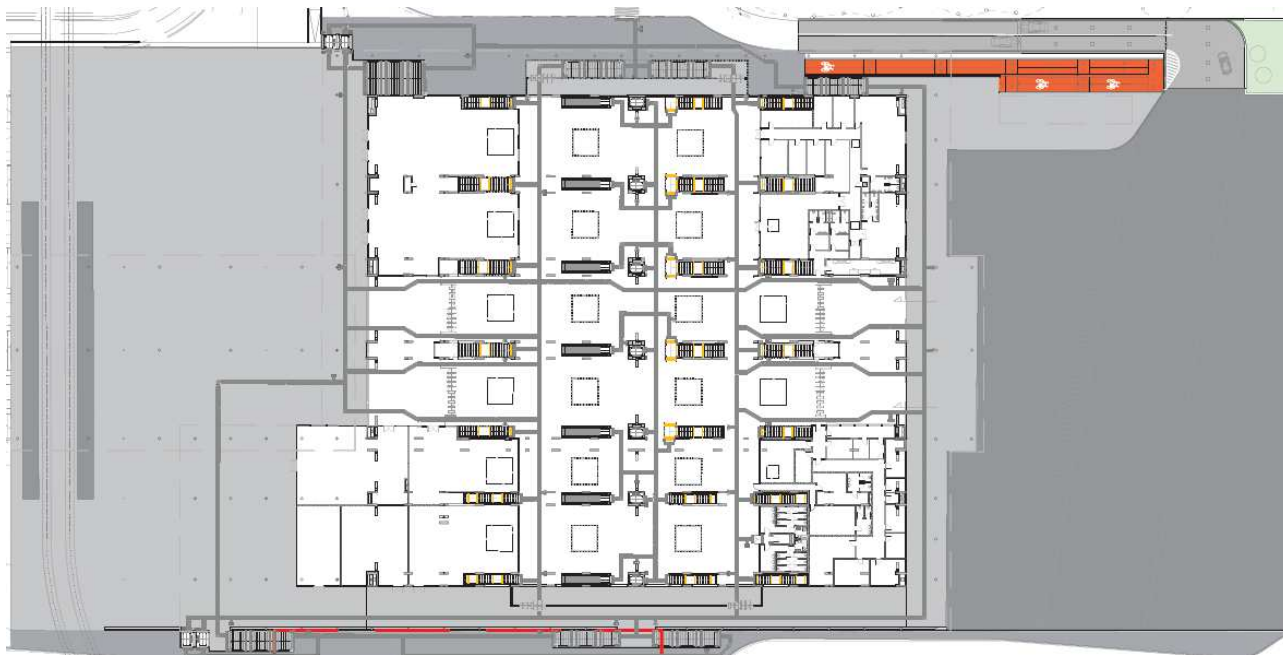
Planimetria Piano Ingressi e piazzali Stazione di Bovisa
